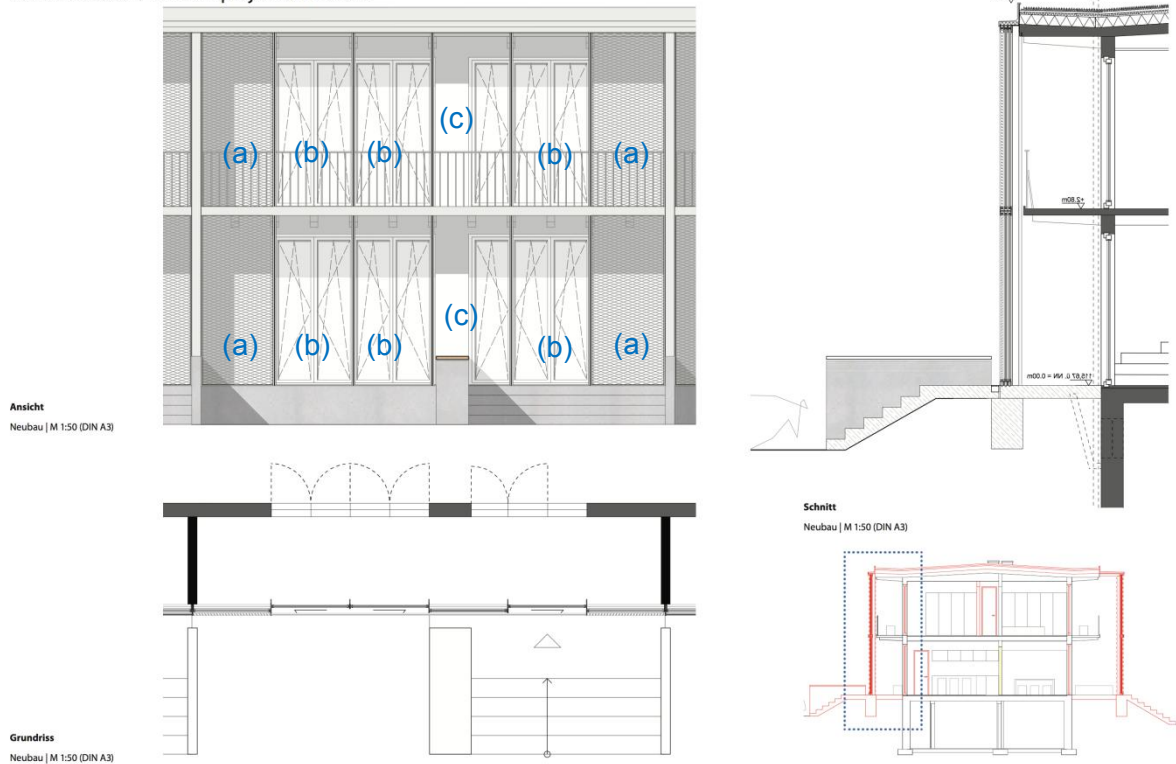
Fassadengestaltung Ansicht West. (a): teilopake Fassadenbereiche bestehend aus Polycarbonat und Streckblechmetall. (b) zu öffnender Fassadenbereich mit Doppelverglasung. (c) nicht zu öffnender Fassadenbereich mit Doppelverglasung. Quelle: Projekt-Zwischenbericht
